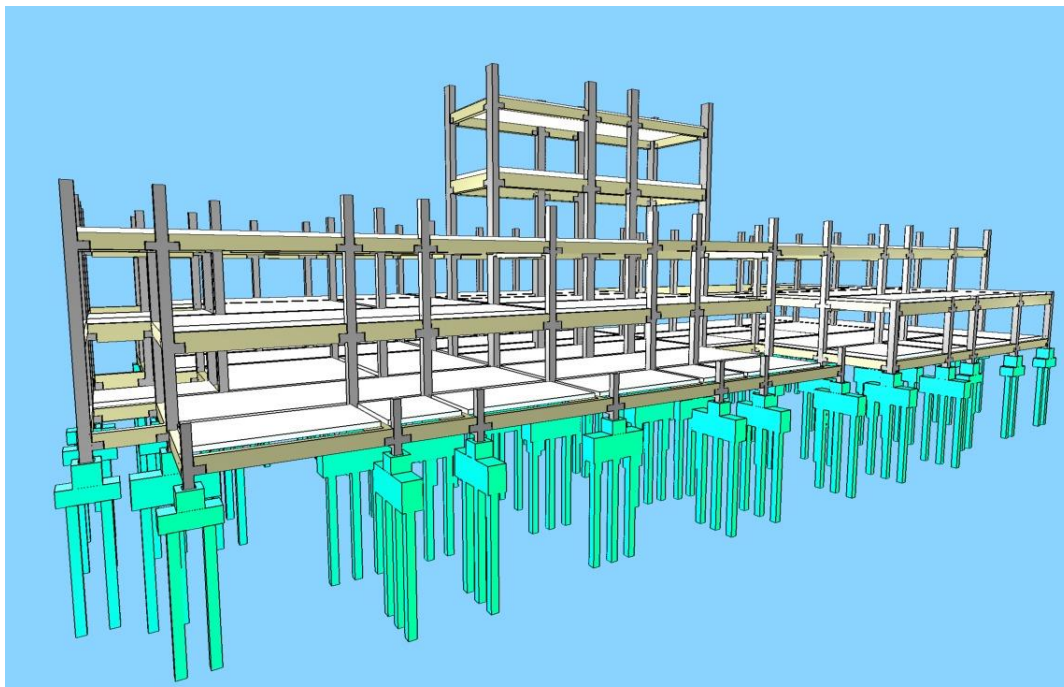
Níveis da estrutura pré-fabricada do CEI
